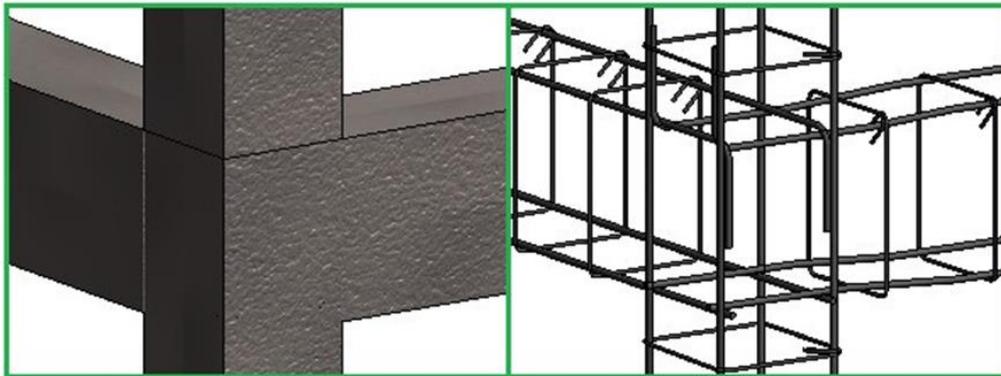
Vista tridimensional da armadura na interseção de duas vigas com um pilar. Fonte: Tarrafa, 2012.
